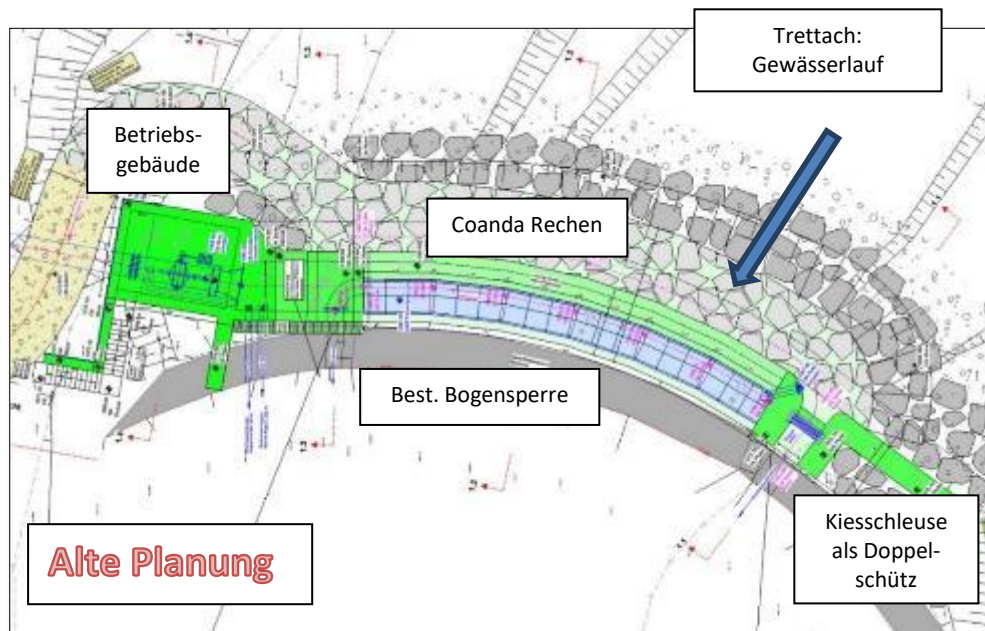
überholte Planung: Draufsicht Fassungsbauwerk
